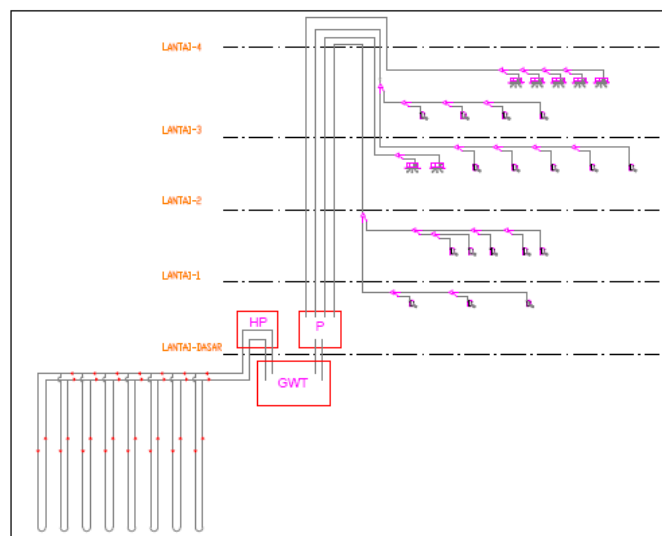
Rencana *ground cooled system* lantai dasar dan lantai 1
